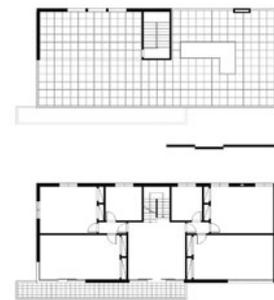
Abaixo, planta do nível Quartos. Acima planta do terraço-jardim.
